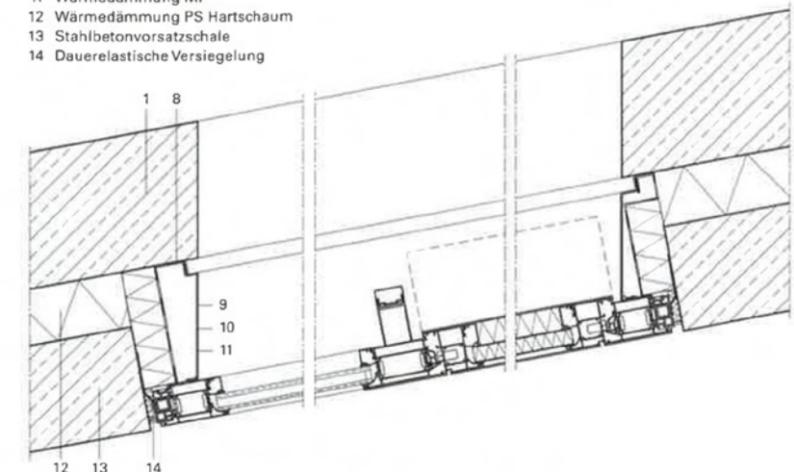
Detail AW-Verkleidung 2. Obergeschoss Skaterrampe, M 1:12,5
